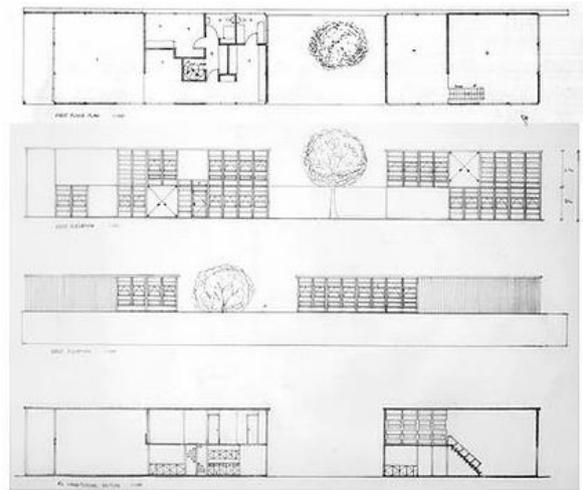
Plan, coupes et élévations_Eames House [Min21].
